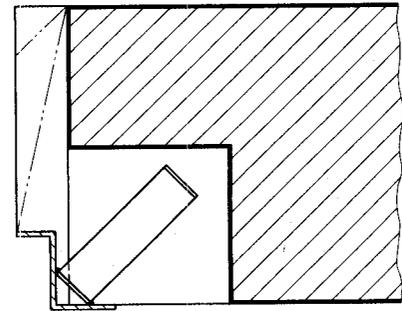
Maueranker, Einbaubeispiel (Grundriß), z.B. dicke Wand, allseitig geputzt
